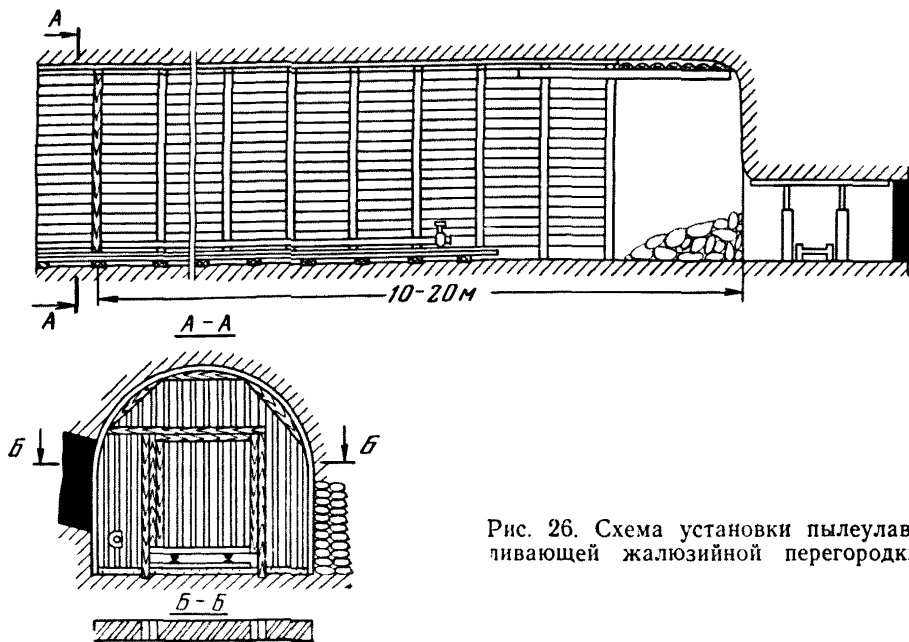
Схема установки пылеулавливающей жалюзийной перегородки
